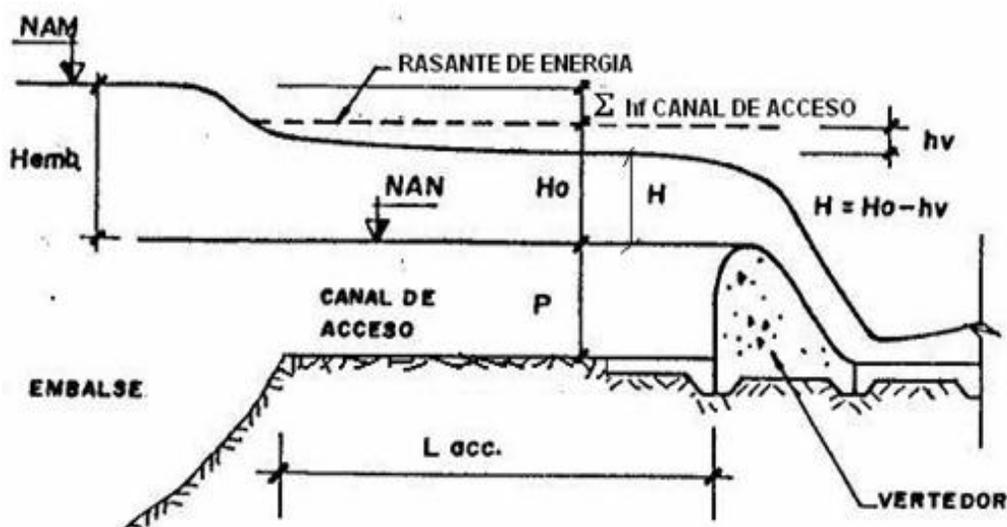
Principales parámetros geométricos e hidráulicos del canal de aproximación.
